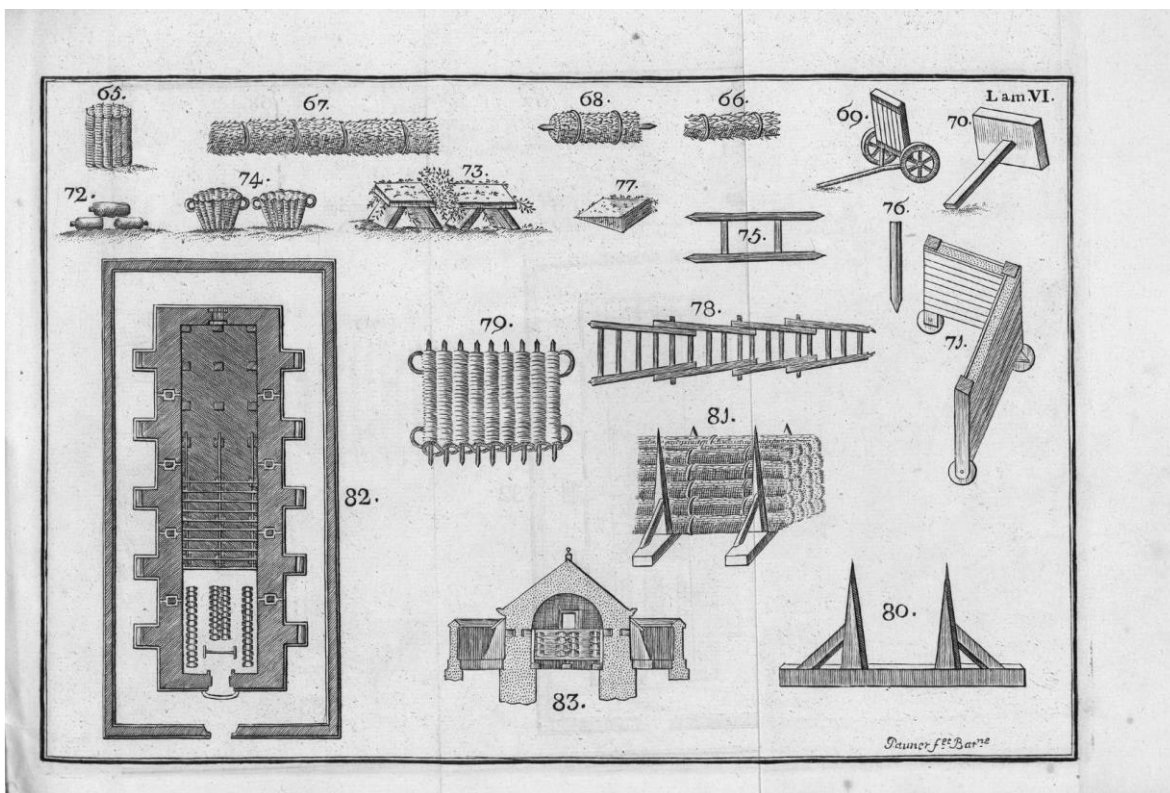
Lámina VI, plano y perfil de un almacén de pólvora a prueba
